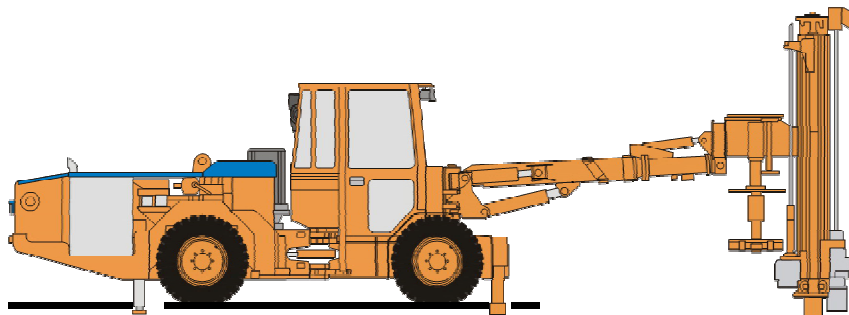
Общий вид установки для крепления анкерами Robolt 5-126 Cabin
